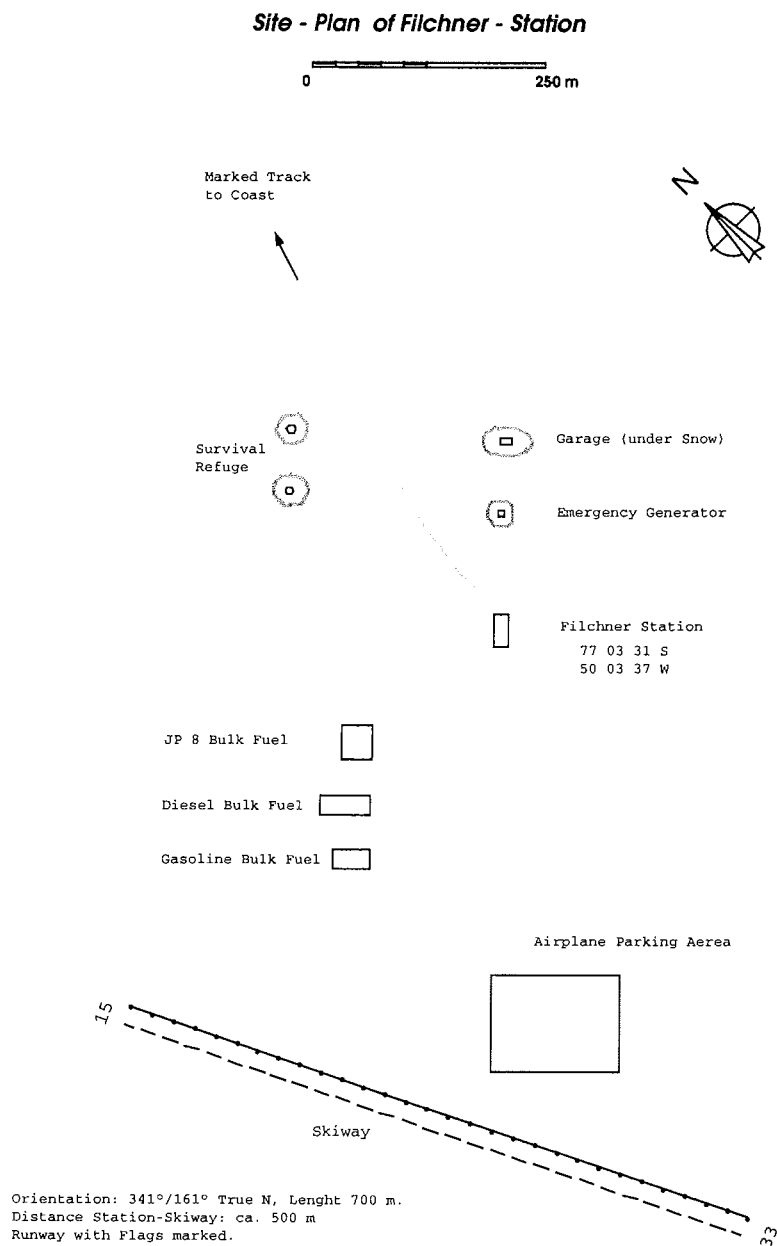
Lageplan der Filchner-Station 1997 vor dem Eisbergabbruch.
